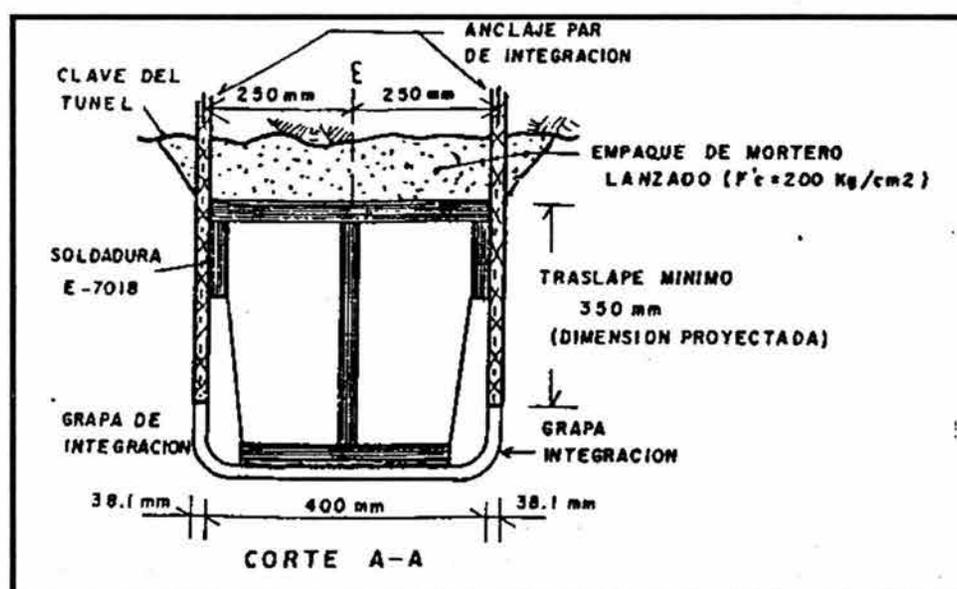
SUJECIÓN DE LAS VIGAS DE SOPORTE
